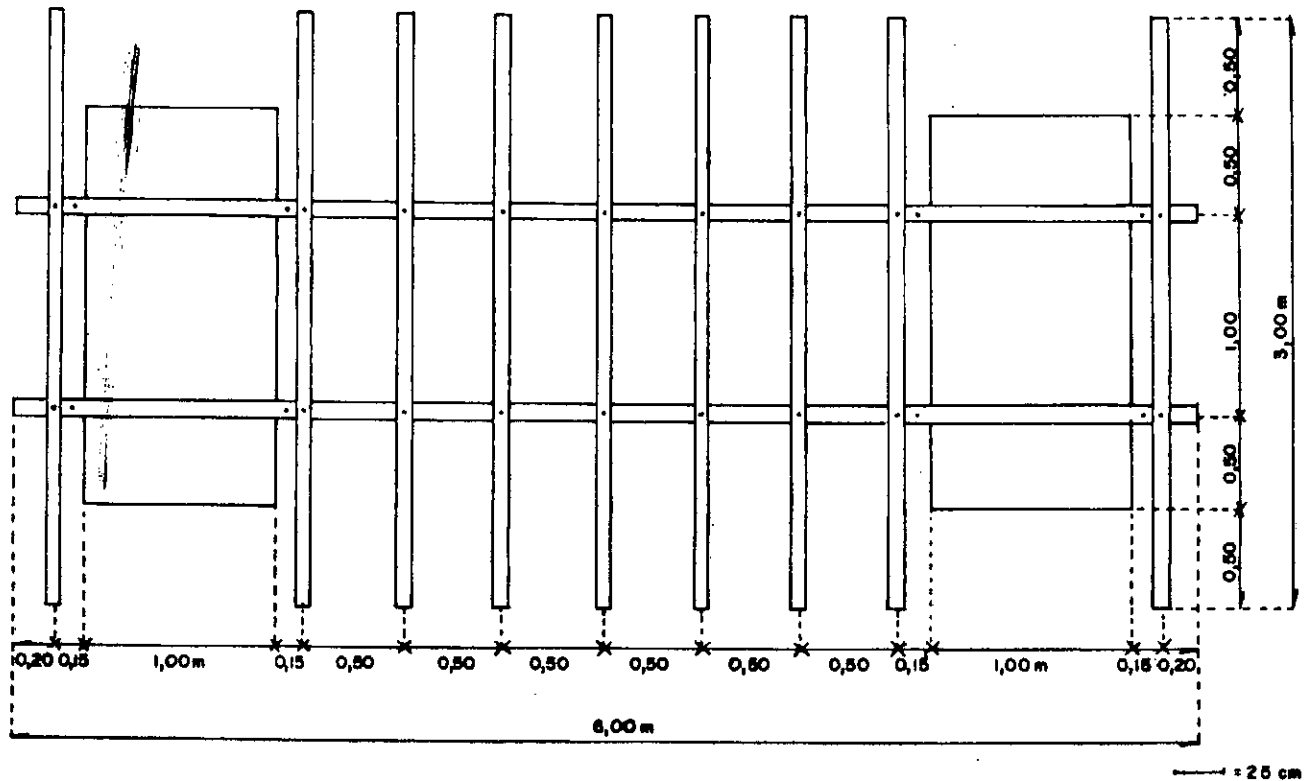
FIGURA I. - Planta Baixa - Balsa de Cultivo (3x6m).
